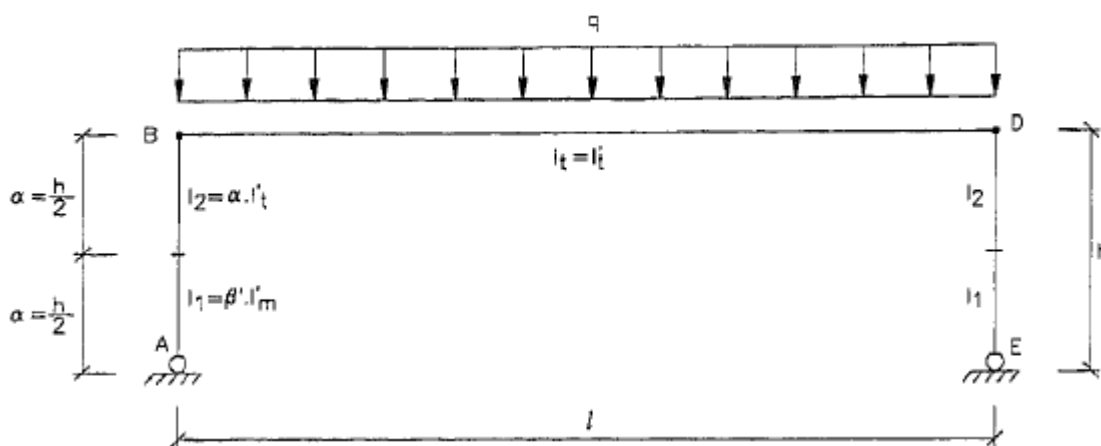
2 - Pórtico com pilares de inércia variável e viga de inércia constante (Pinto, 1997).
